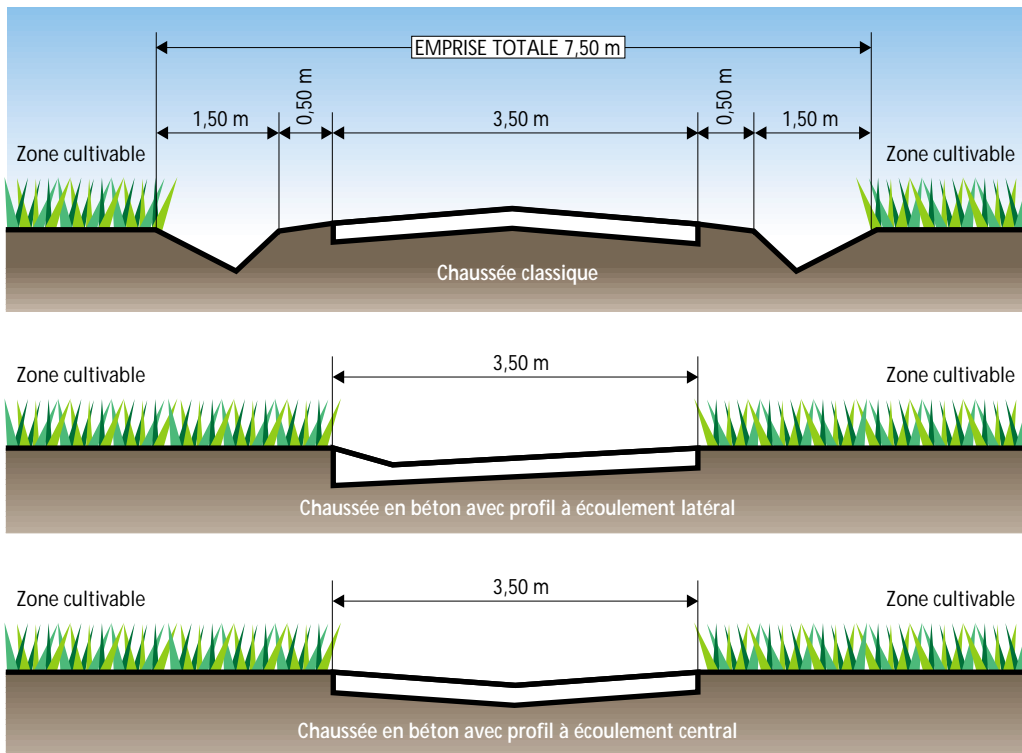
Profils en travers types d'une chaussée classique et d'une chaussée en béton
